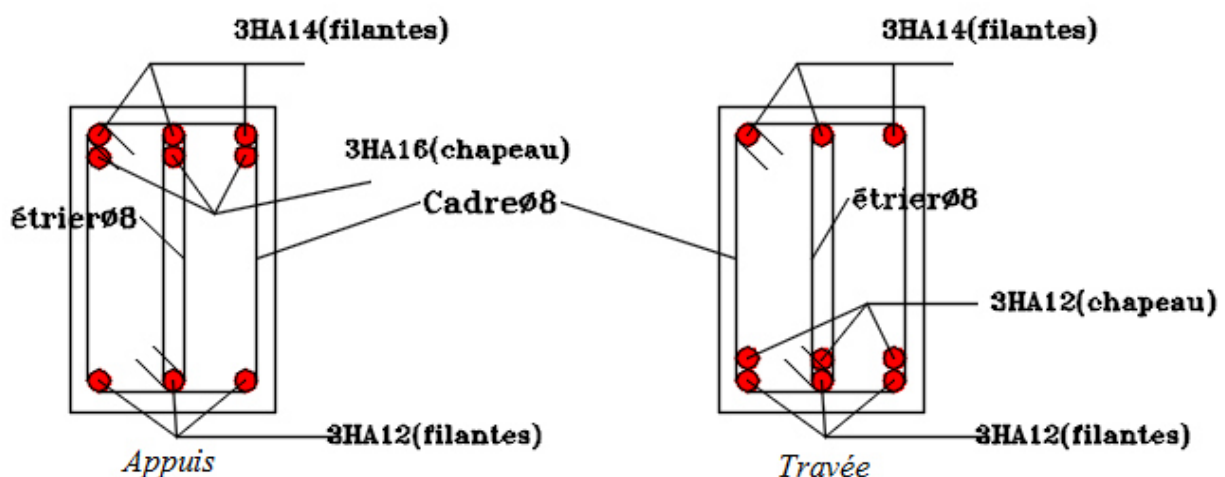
Schéma de ferrailage des poutres principales du RDC
